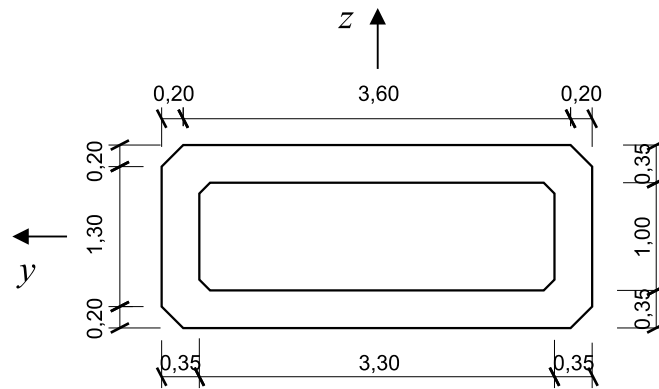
Sección transversal de las pilas (se representan ejes locales de pila a los que se refieren los esfuerzos en la misma)
